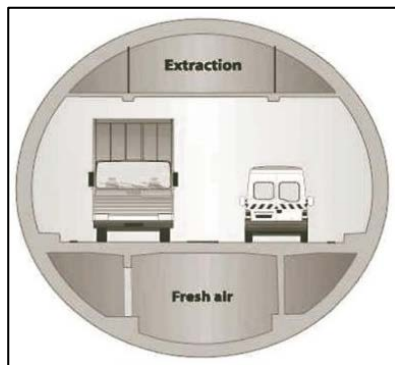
Sección de túnel carretero circular con una calzada y un sistema de ventilación conducido.
